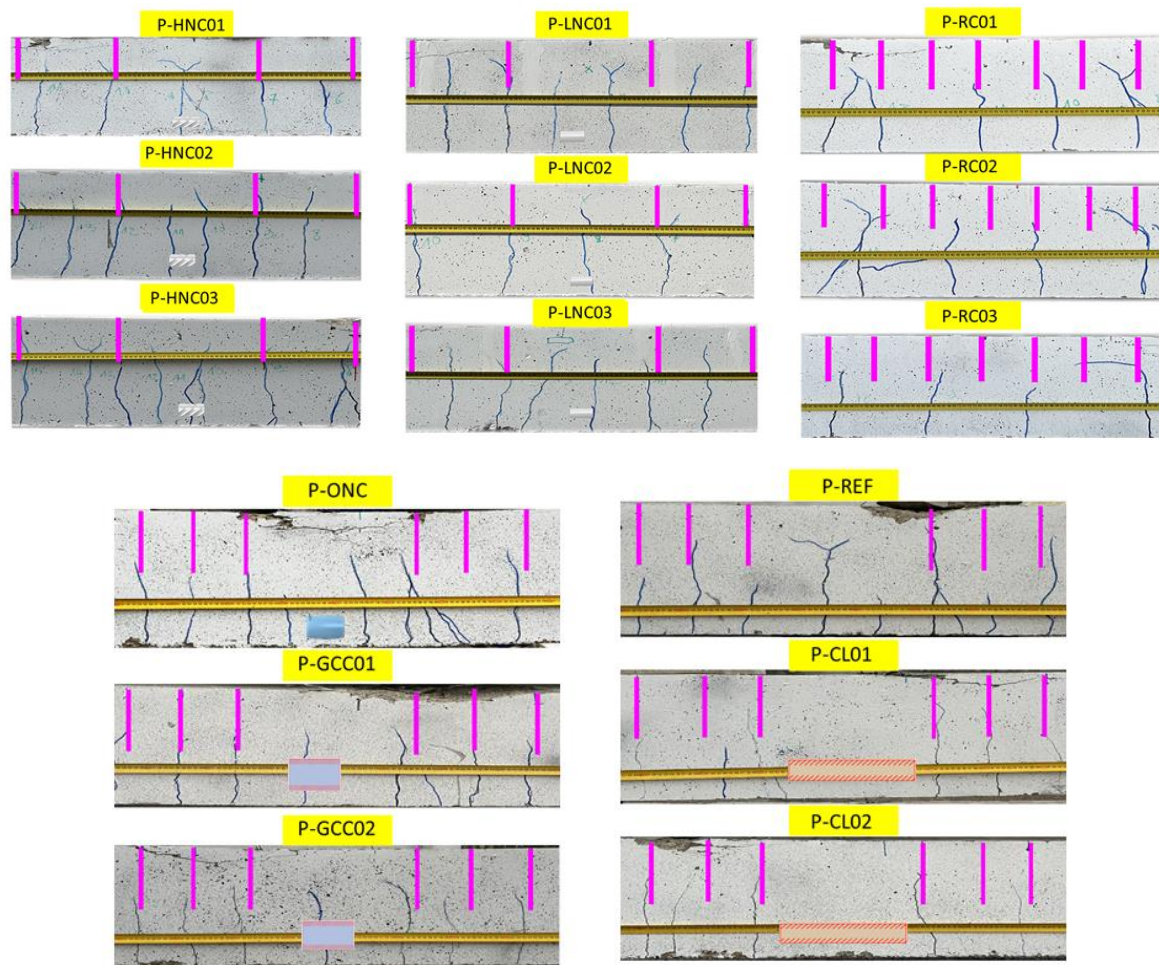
20 : État de fissuration des poutres avec différentes configurations de liaisonnement après la rupture.
